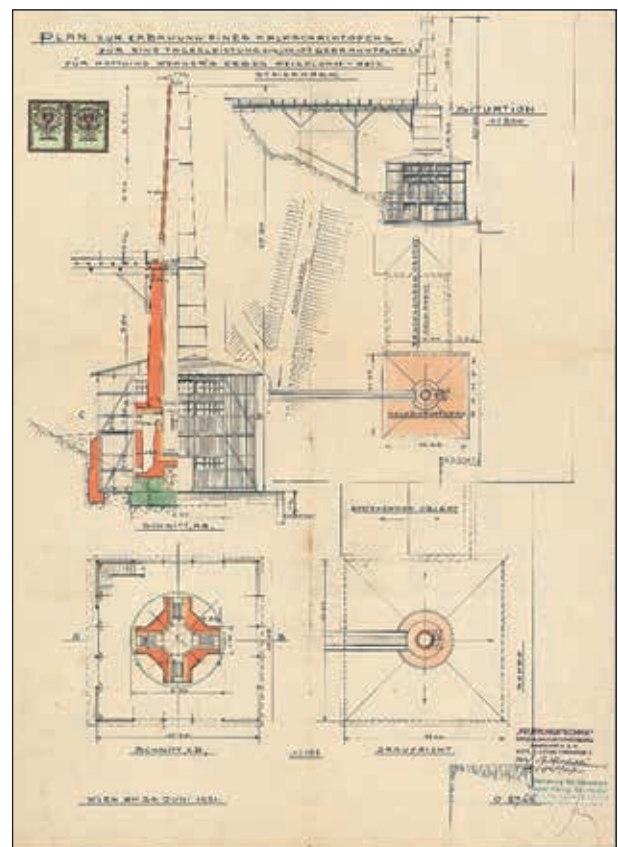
Plan zur Erbauung eines Kalkschachtöfens (Sammlung HAUSLEITNER)
